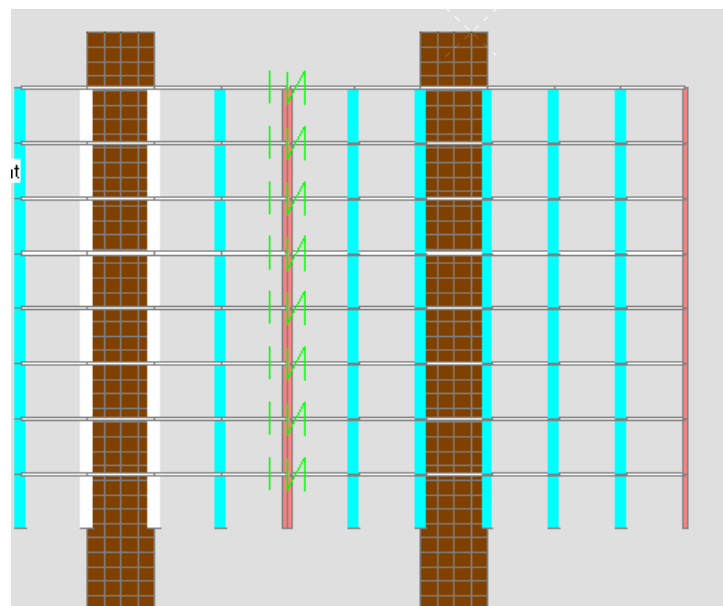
Deux noyaux de 30cm pour les 2 bâtiments plan x-z.
